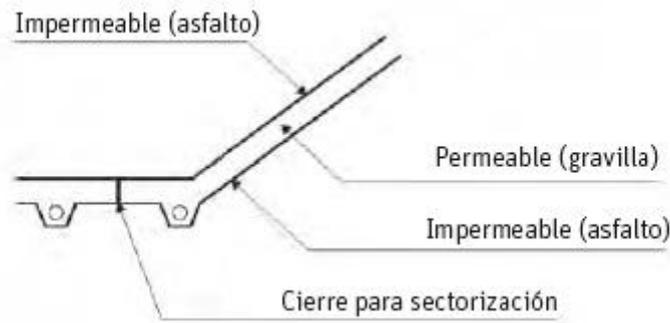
Sección tipo drenaje de detección. Guía para el proyecto y construcción de balsas de tierra.
